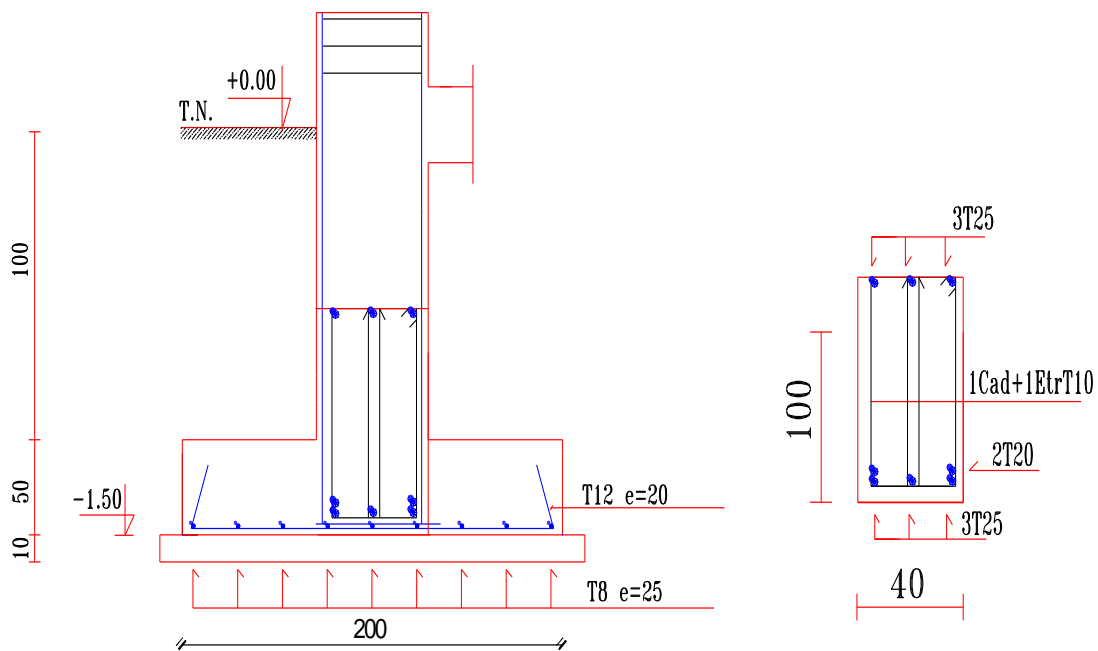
Schéma de ferrailage des semelles filantes appui Y-Y
